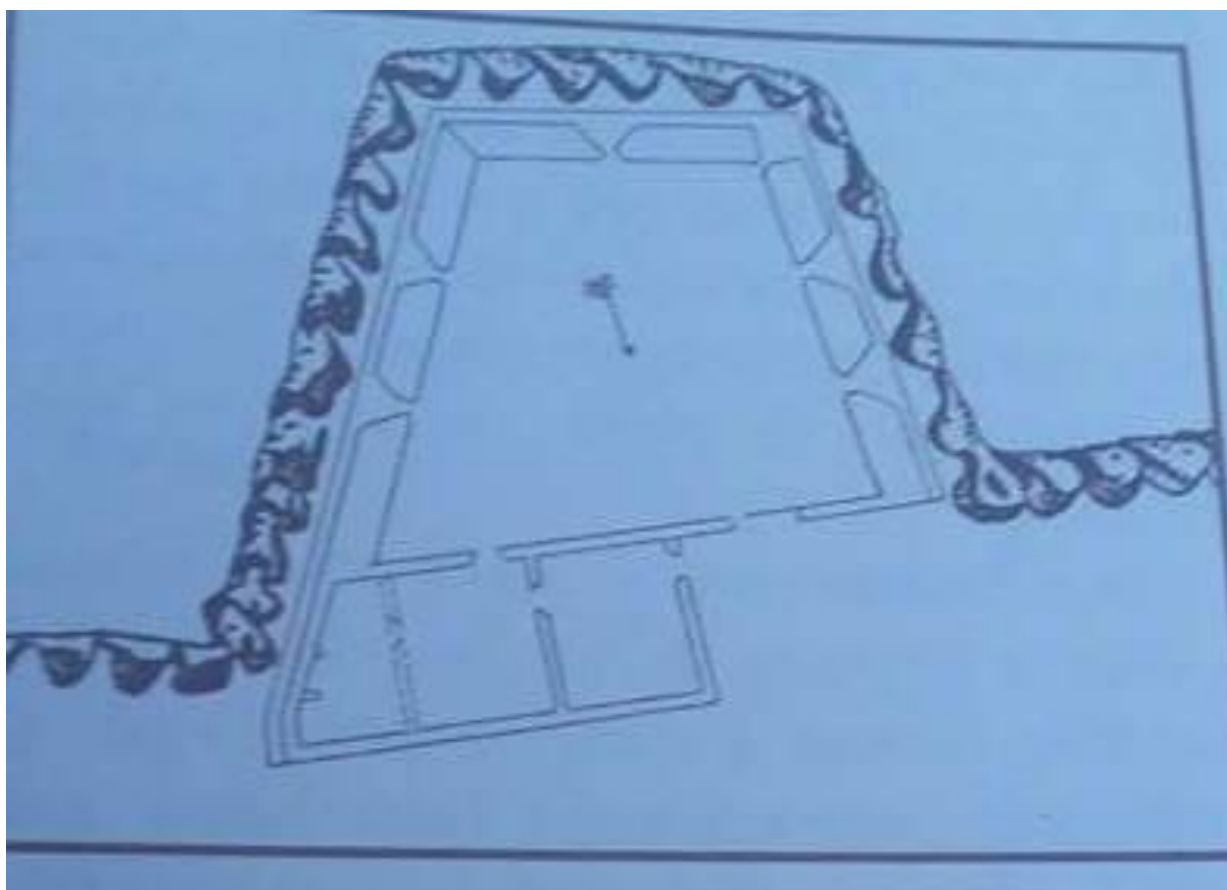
Planta do Forte de Nossa Senhora da Boa Viagem
